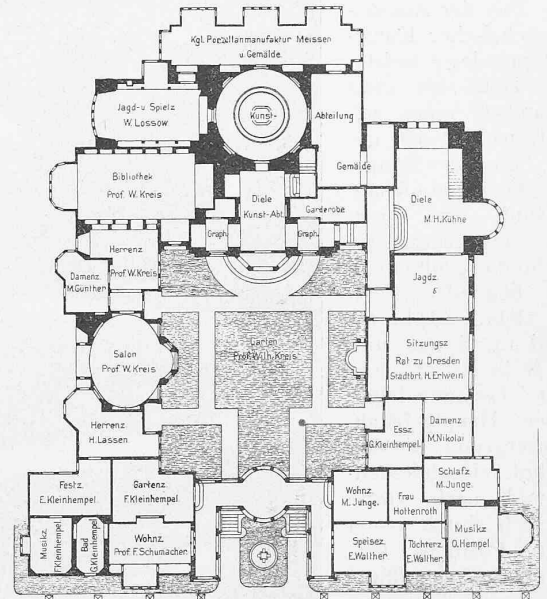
Grundriss des «Sächsischen Hauses». — 1 : 600.
